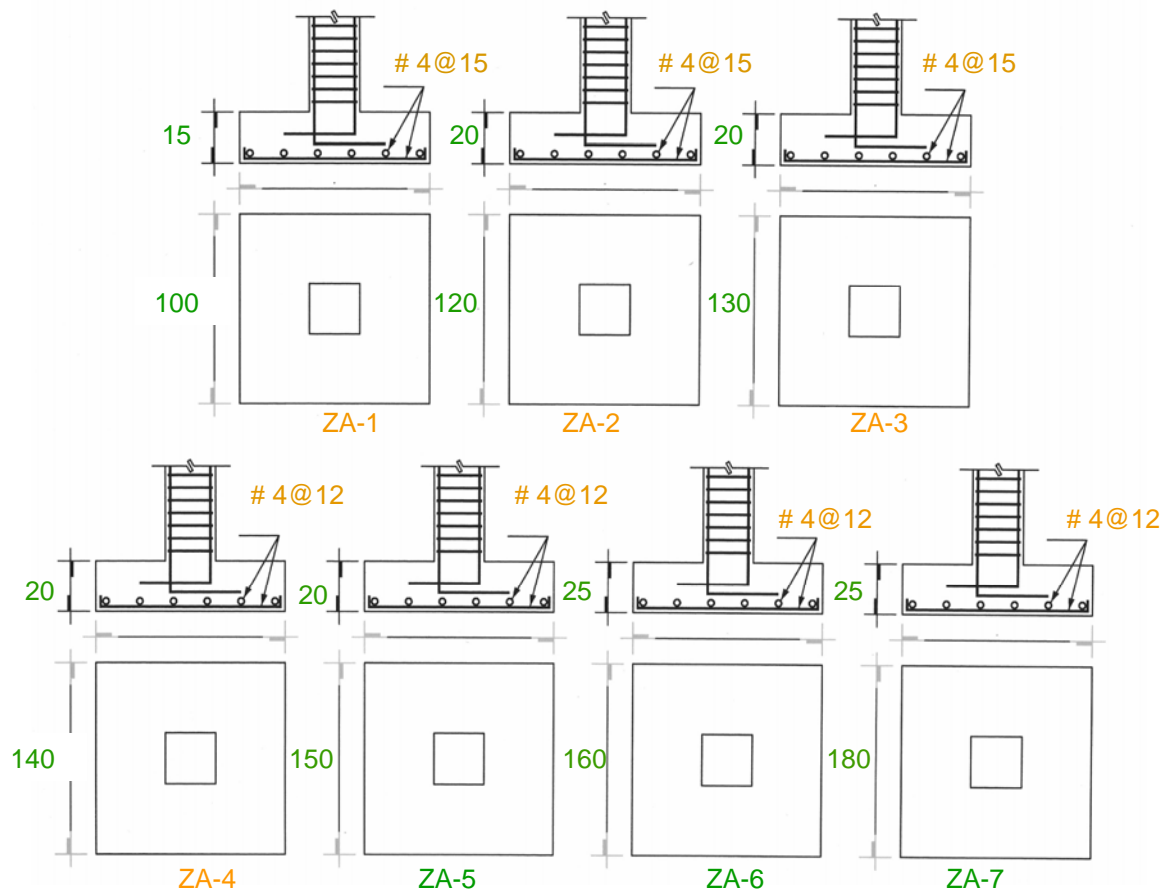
Zapatas aisladas que se diseñaron para esta nave en particular
